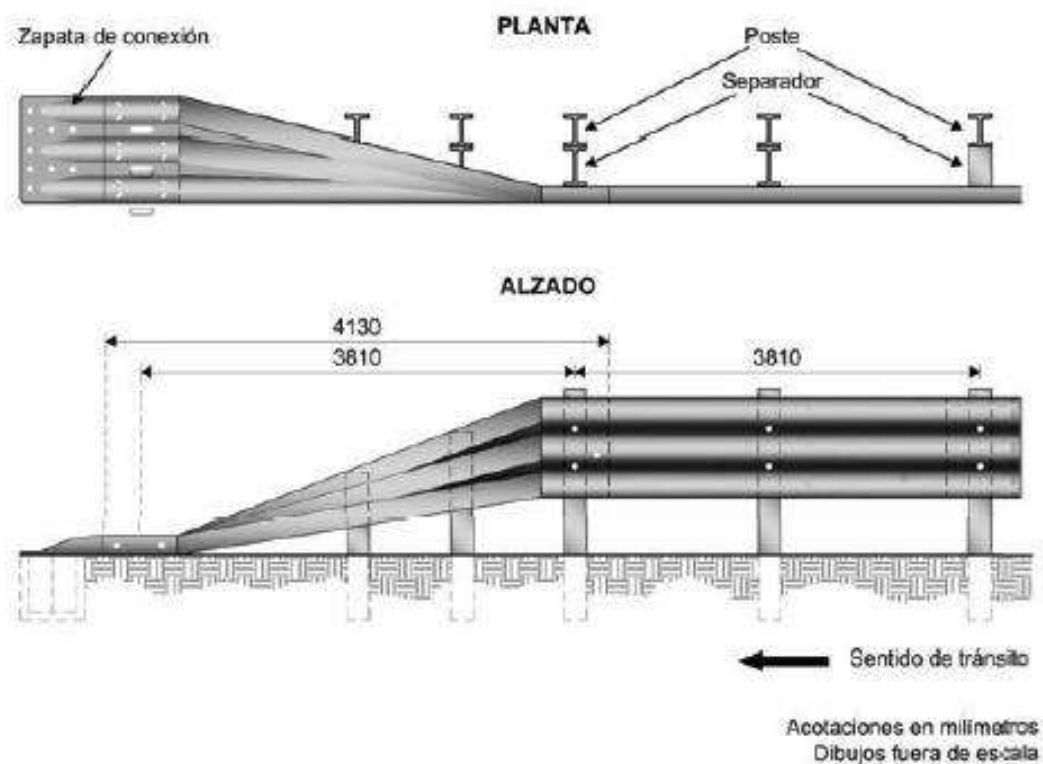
Secciones terminales Sencillas para vigas acanaladas de dos y tres crestas (OD-4.4.2/S).
